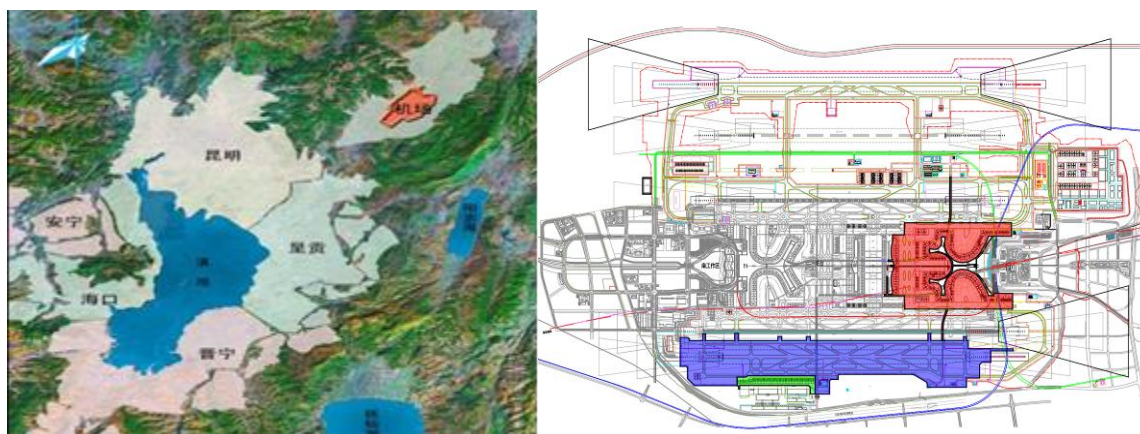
本项目的位臵示意图、平面图 (颜色填充部分为亚投行贷款支持项目)
